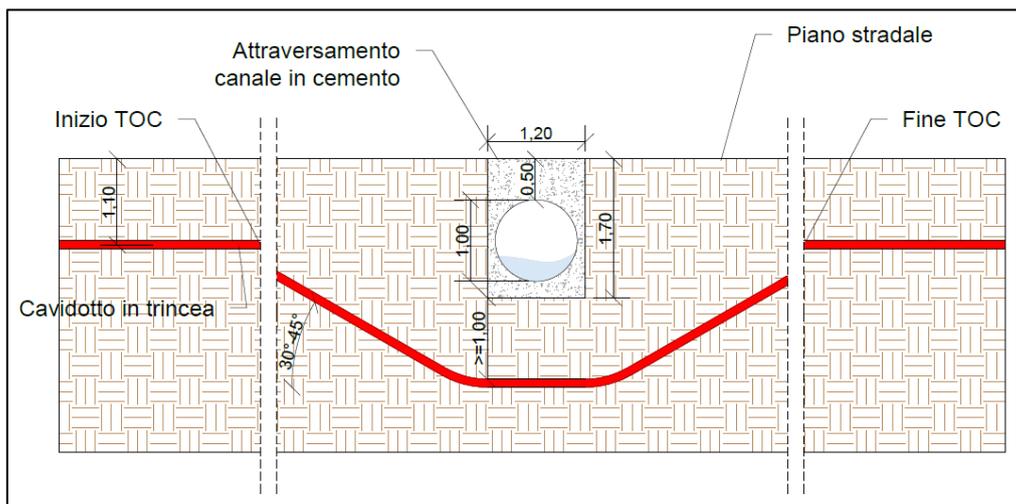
Attraversamento n. 26 - Sezione tipologica attraversamento tramite TOC
